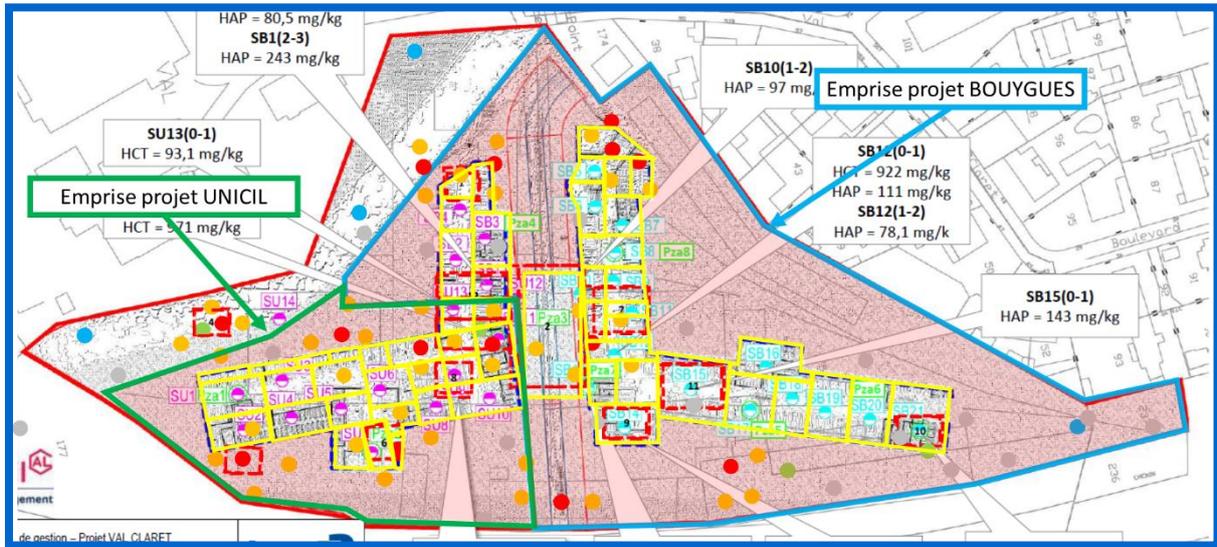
Plan de maillage (Cf. Annexe n°2)
